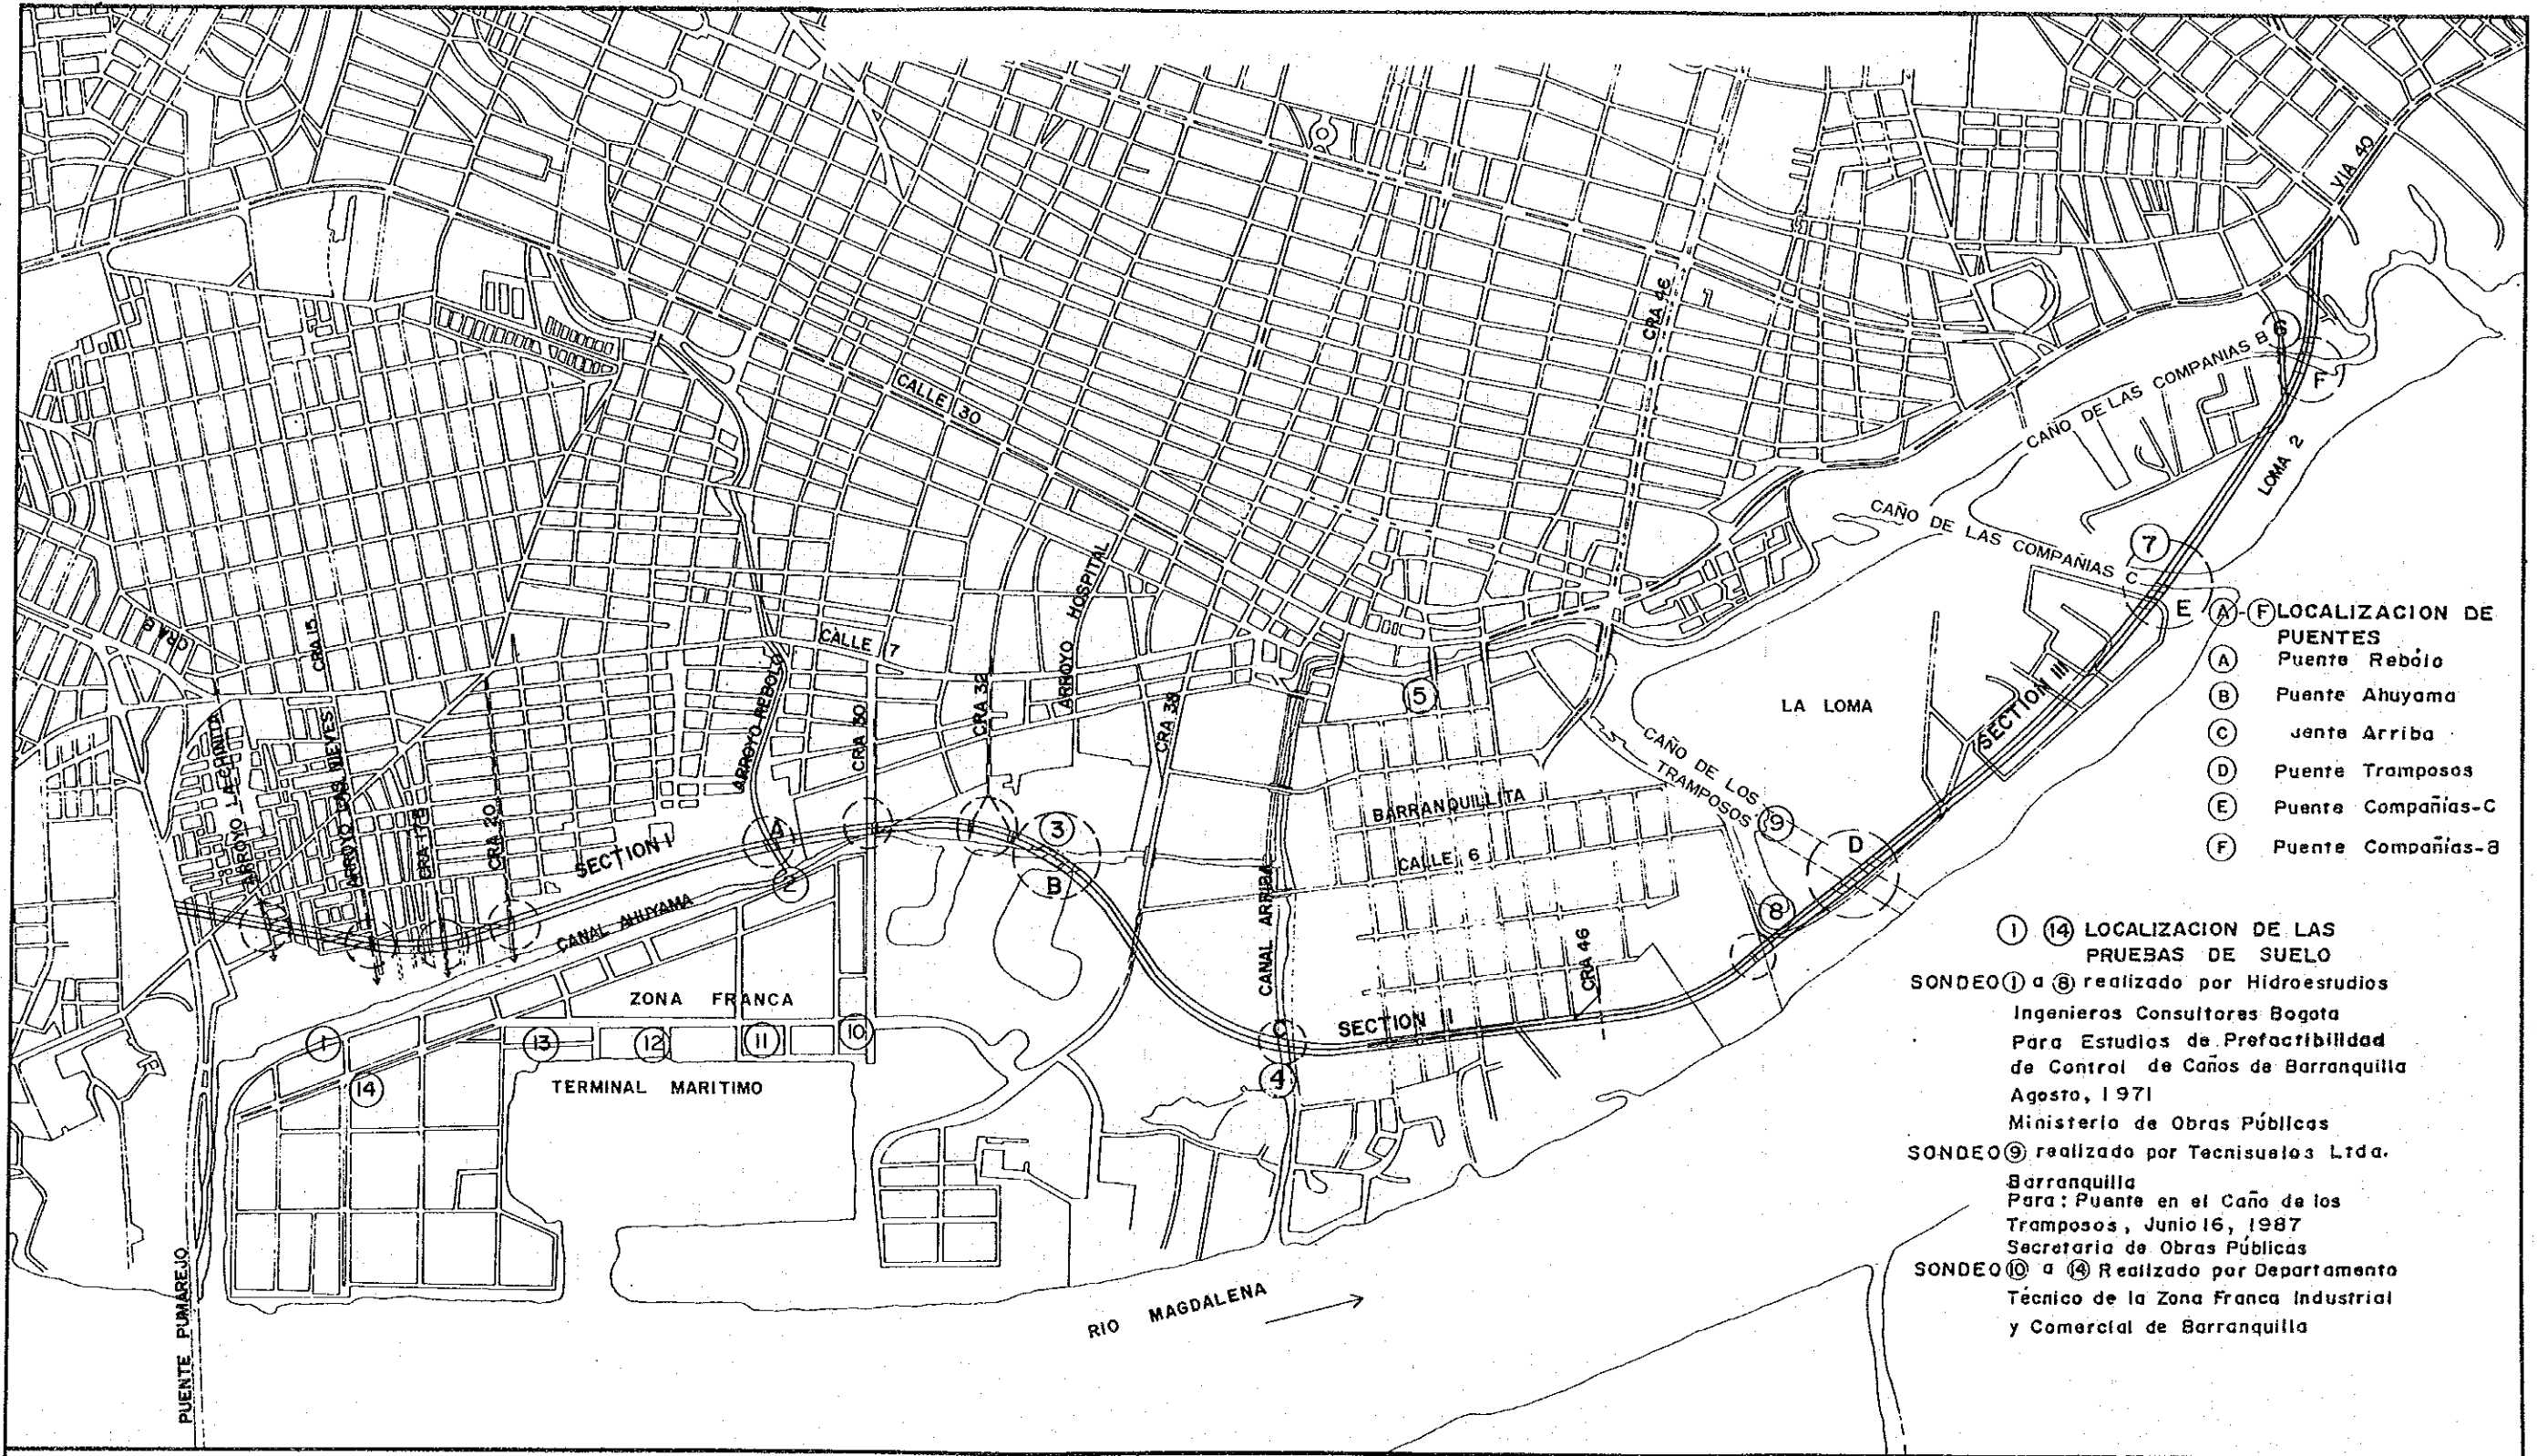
ESTRUCTURAS A LO LARGO DE LA AVENIDA DEL RIO
